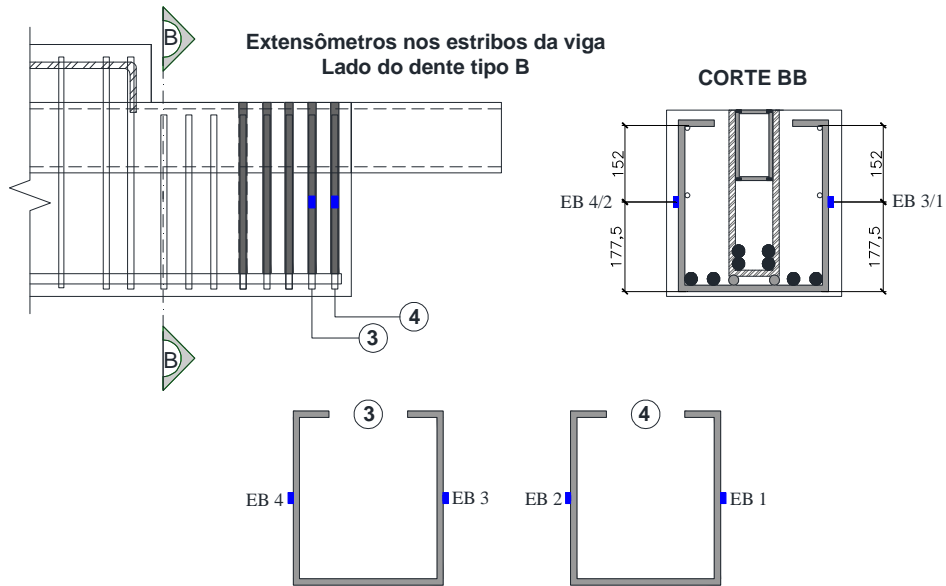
Posicionamento dos extensômetros nos estribos da viga do dente-12,5 (ver detalhe completo na Figura 3.34)
